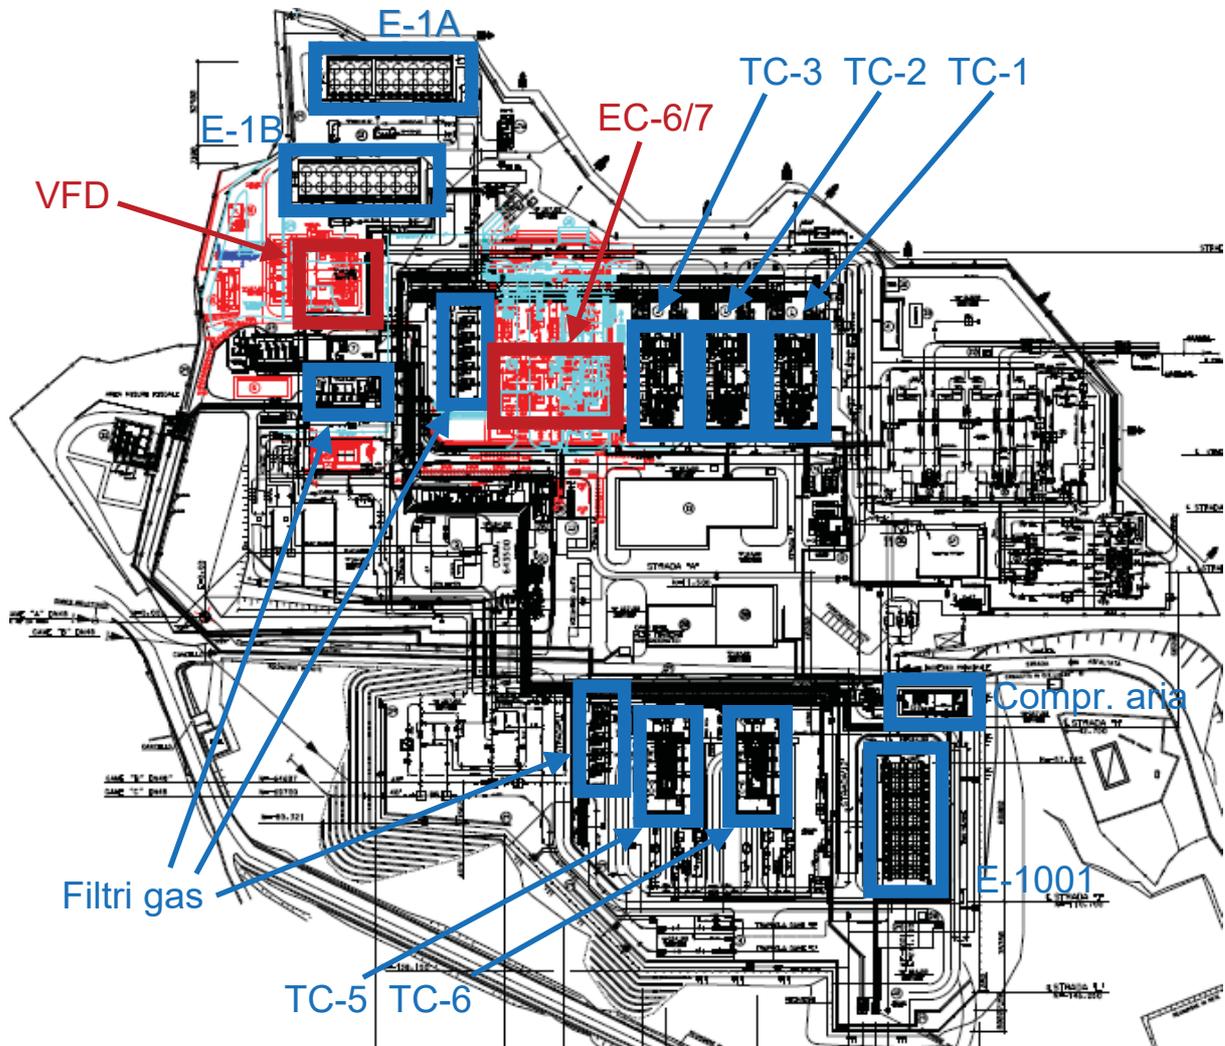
Planimetria dell'impianto con la localizzazione delle sorgenti rumorose rilevanti di nuova costruzione (in rosso) e preesistenti (in blu)
